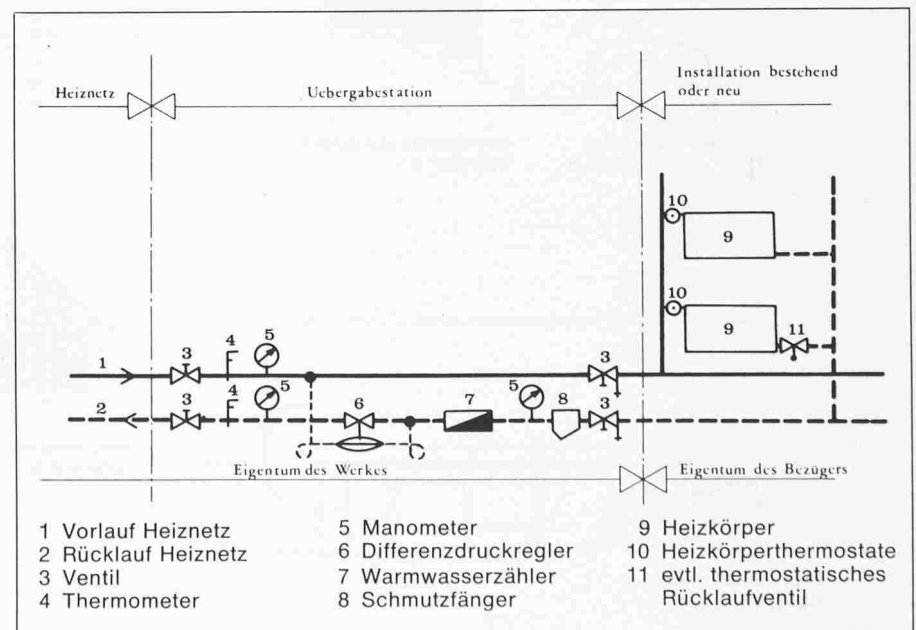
Hausanschluss Heizung, Hausinstallation neu
